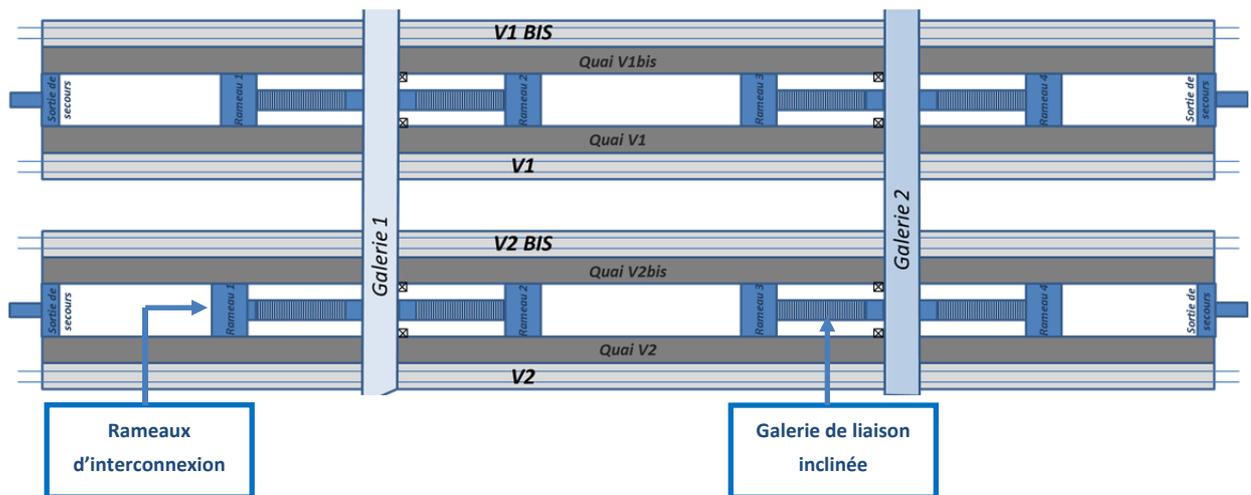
schéma en plan de la configuration 4 tubes proposée
